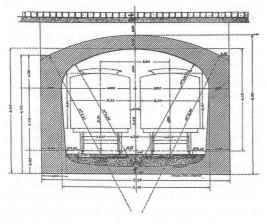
Sección tipo de túnel ejecutado en zanja abierta (Otamendi 1918, 246)
